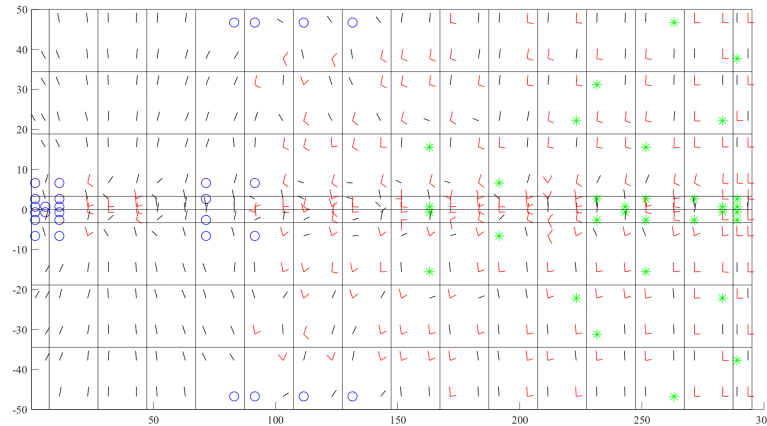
Padrão de fissuração na camada inferior da laje de concreto (viga B1GB60), (ELU)
